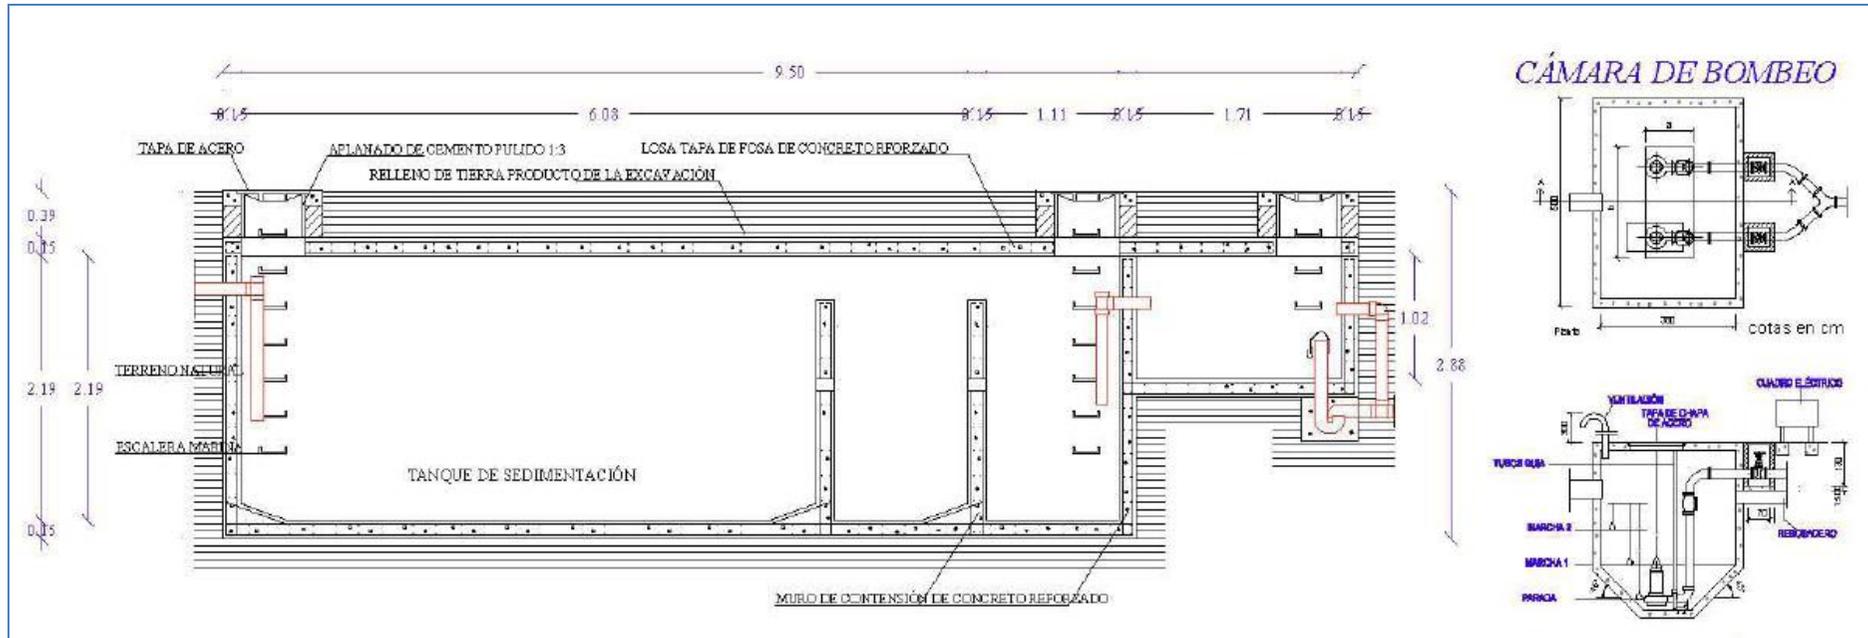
Tanque de sedimentación.<sup>43</sup>
